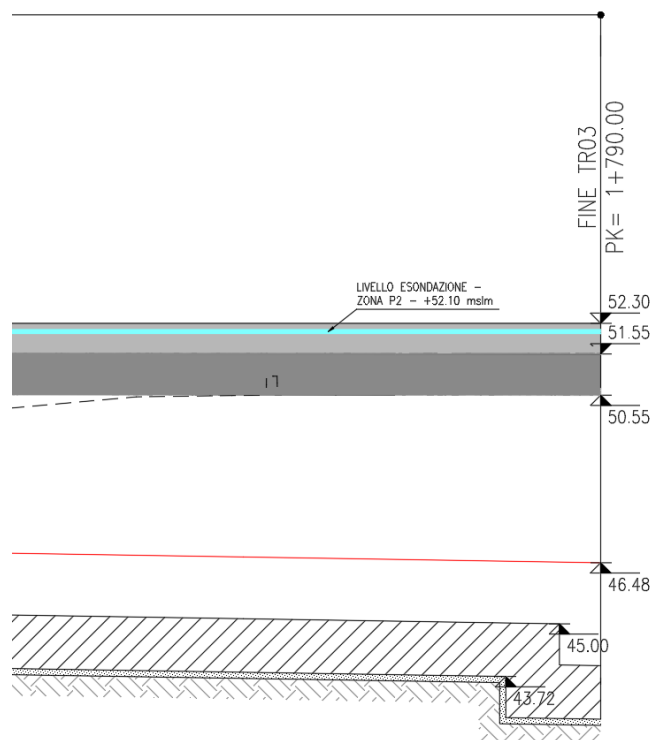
Profilo longitudinale TR03 – imbocco galleria Nord BP
